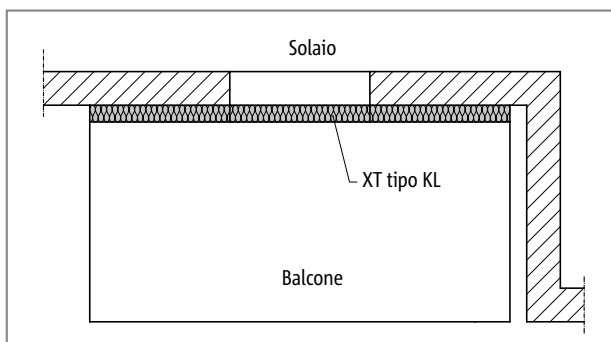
Schöck Isokorb® XT tipo KL: balcone con elementi sporgenti nella facciata
